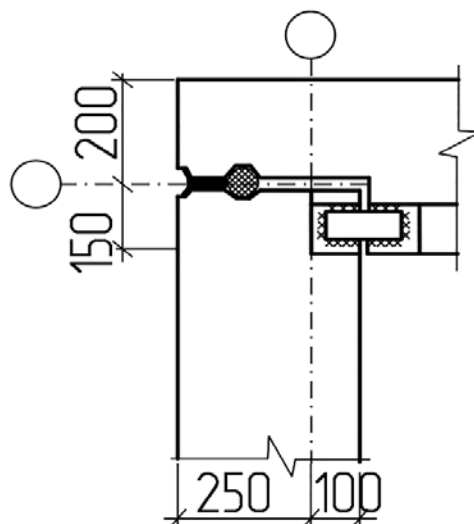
Стык керамзитобетонных стеновых панелей в углу здания
